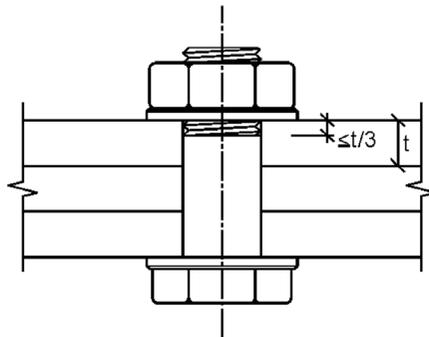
Ins Schraubenloch hineinragendes Gewinde einer Passschraube /4/
